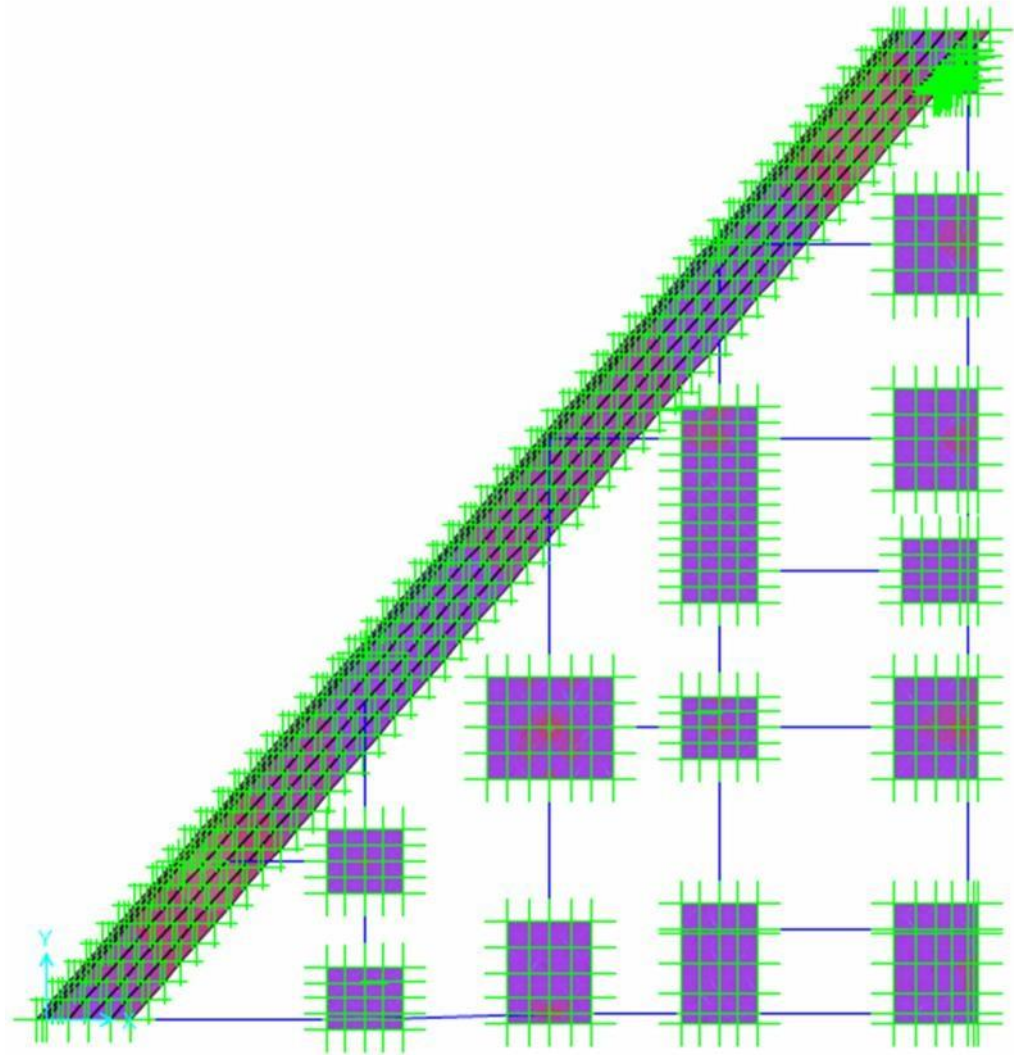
Refuerzo transversal (Ast2) cara exterior.
